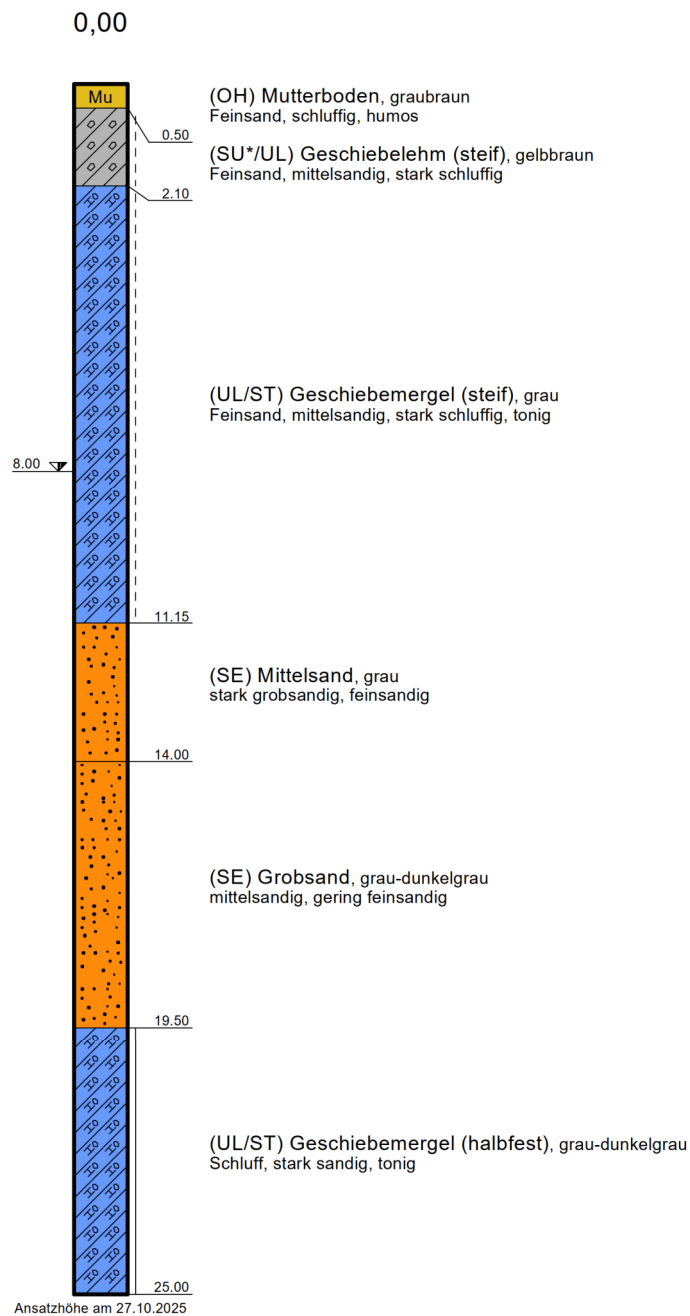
Exemplarische Baugrundsichtung (Geotechnischer Bericht, baulab Prüfstelle Brandenburg vom 17.11.2025)
